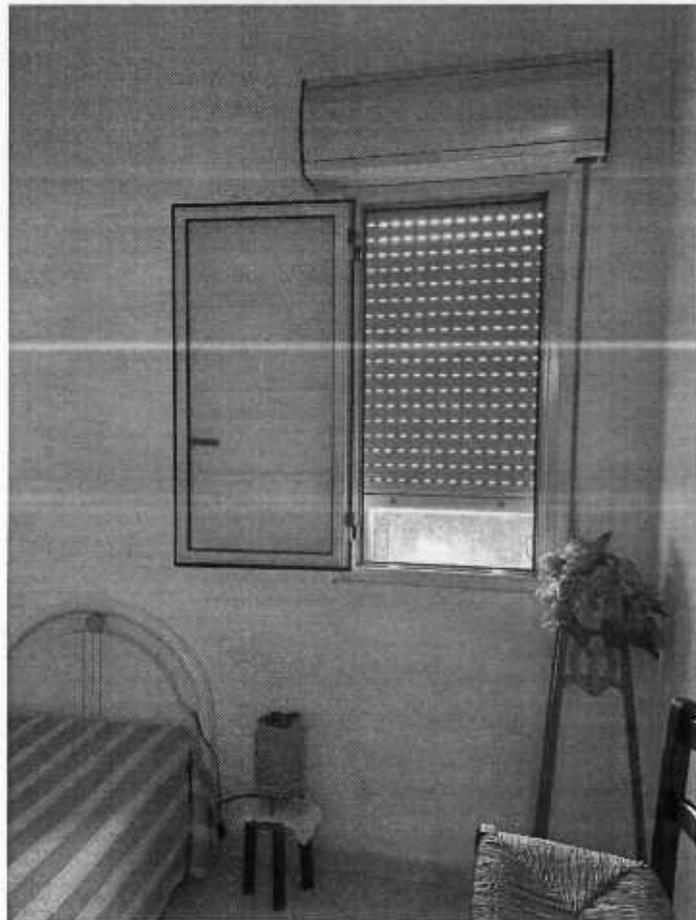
vano ripostiglio a piano primo adibito a camera da letto singola
